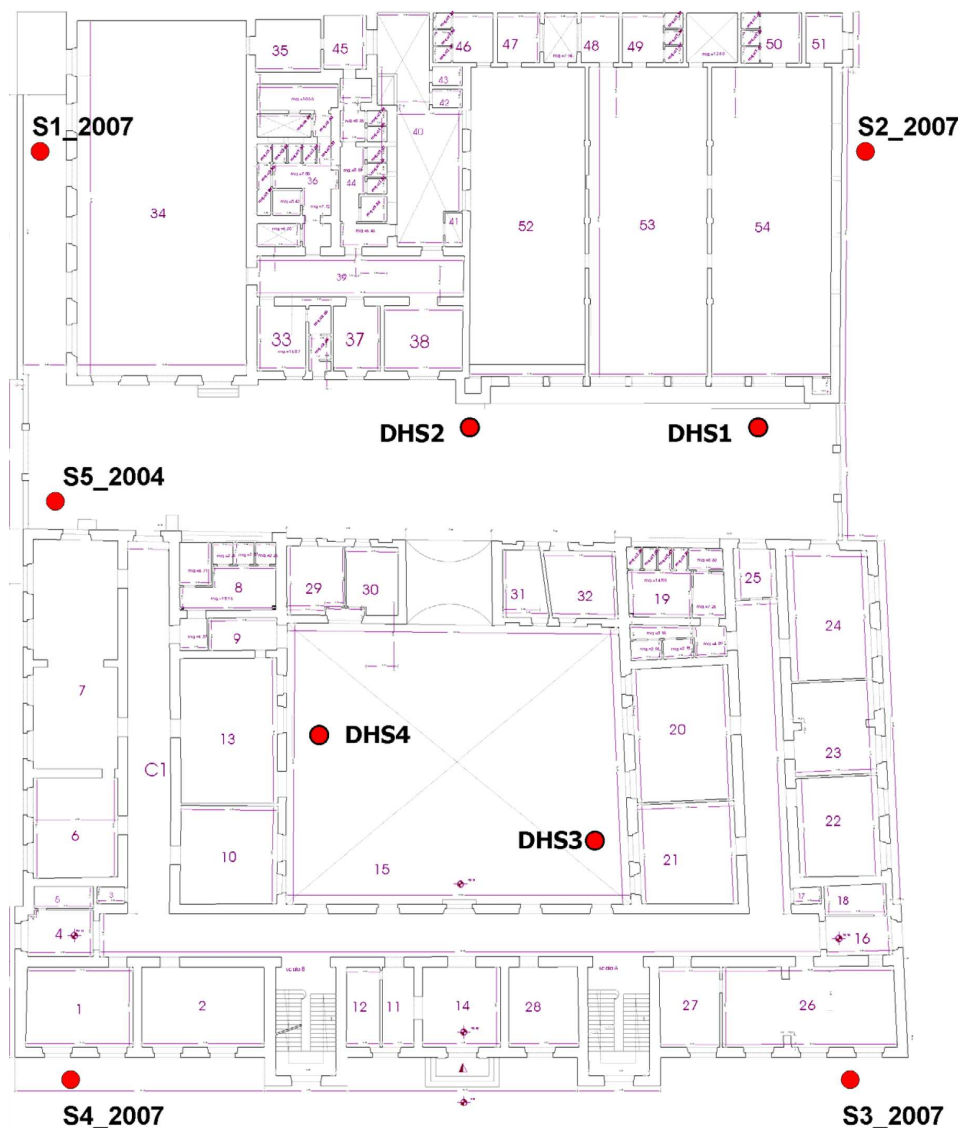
Planimetria con Ubicazione dei Sondaggi Campagna 2007.
